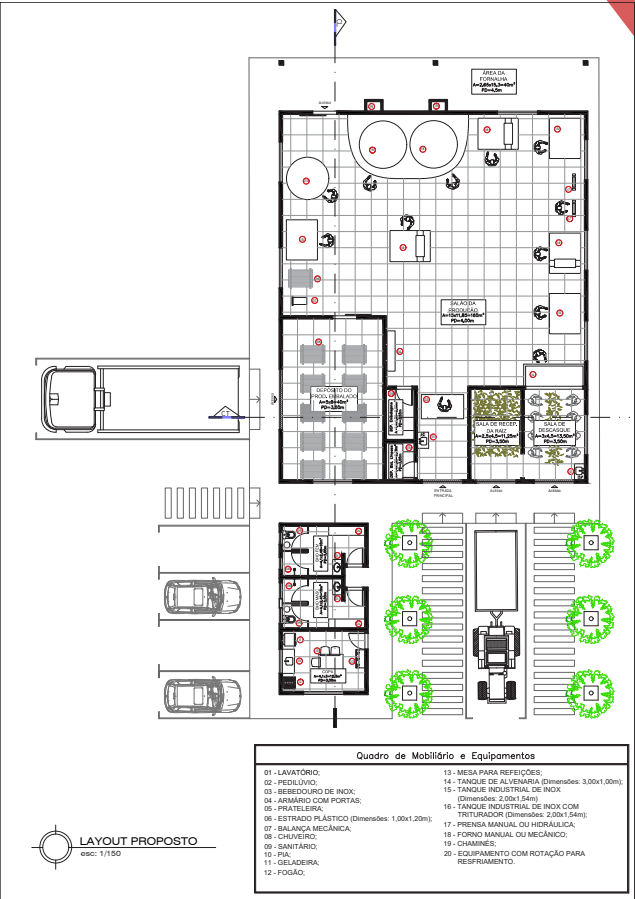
Planta baixa de uma casa de farinha conforme a legislação vigente
